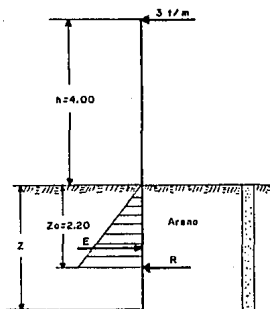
Tablestacado empotrado en el terreno y sometido a una carga lineal
